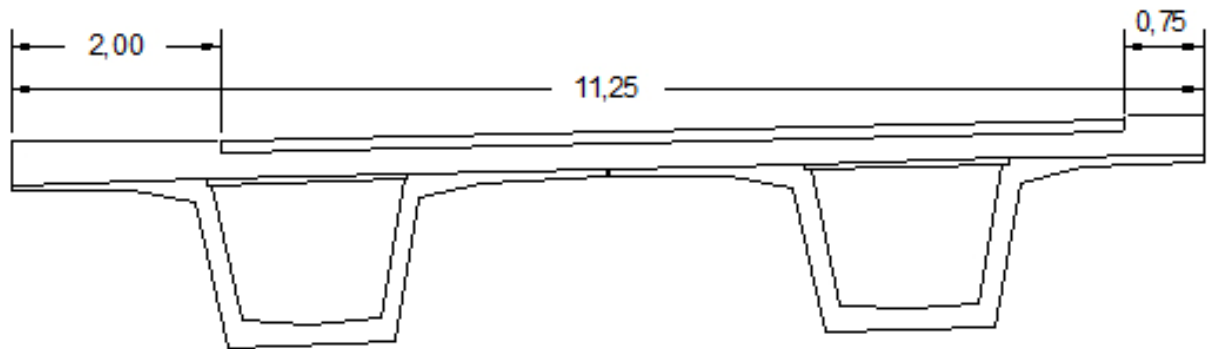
Sezione trasversale dell'impalcato in mezzeria
